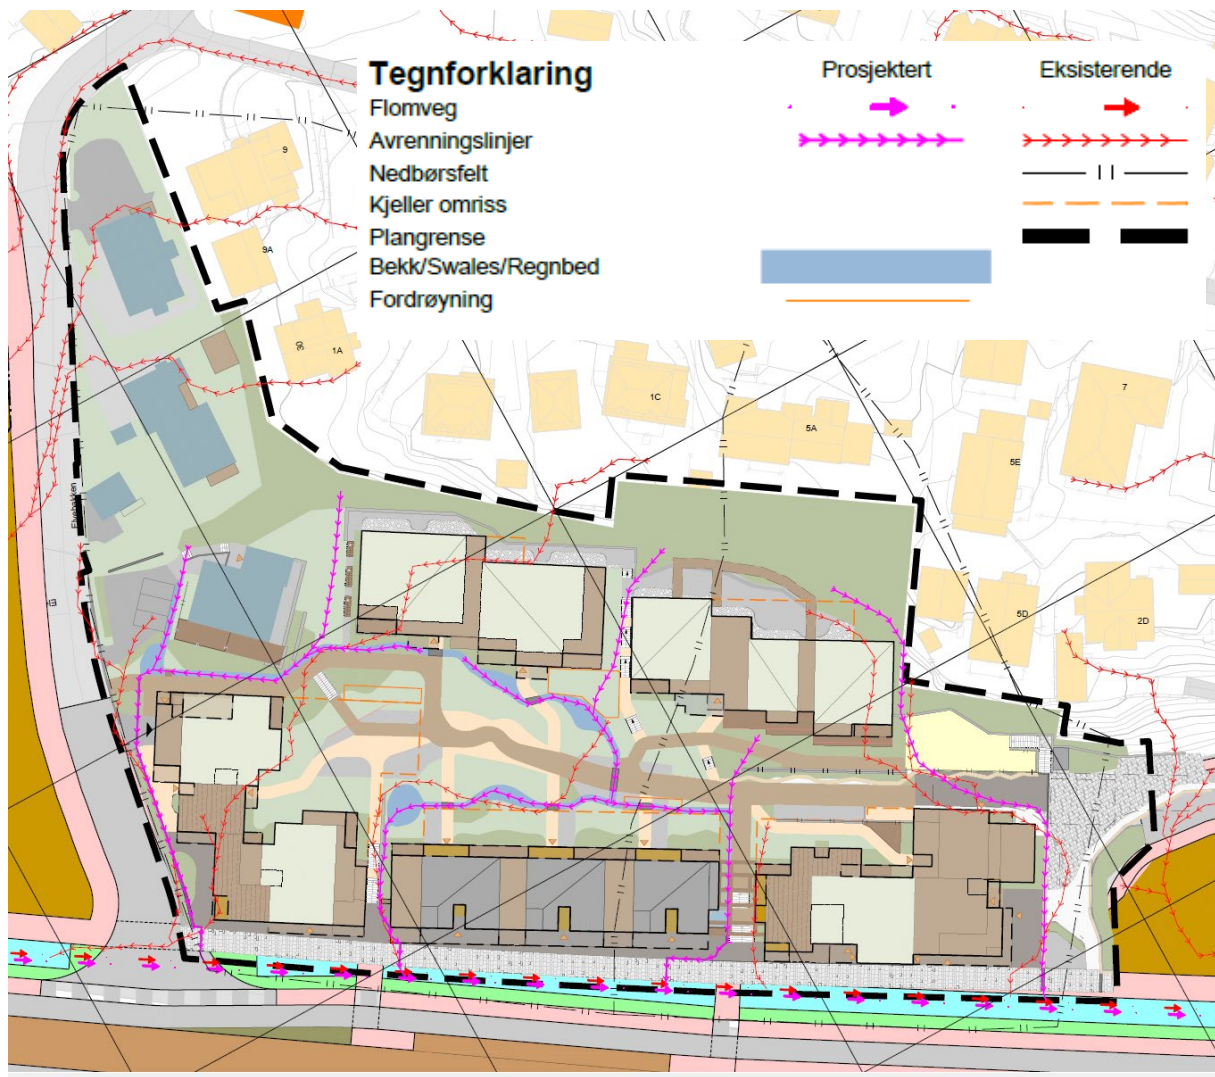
Fra VA-rammeplan, tegning Q100, all planlagt infrastruktur.
